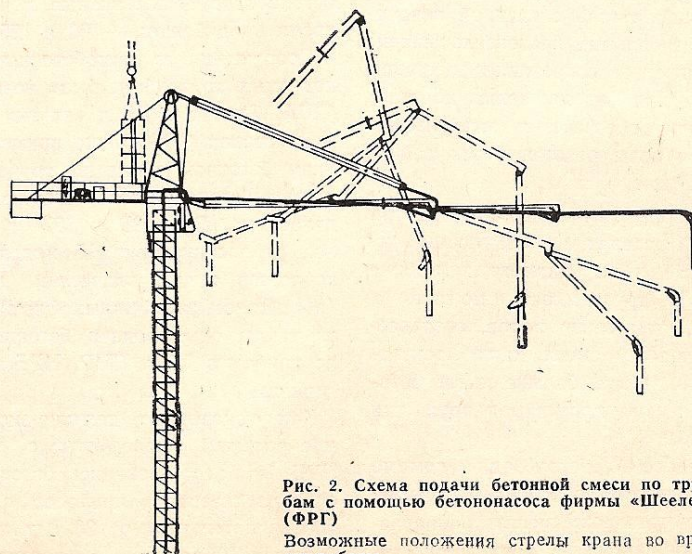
Схема подачи бетонной смеси по трубам с помощью бетононасоса фирмы «Шееле» (ФРГ)
